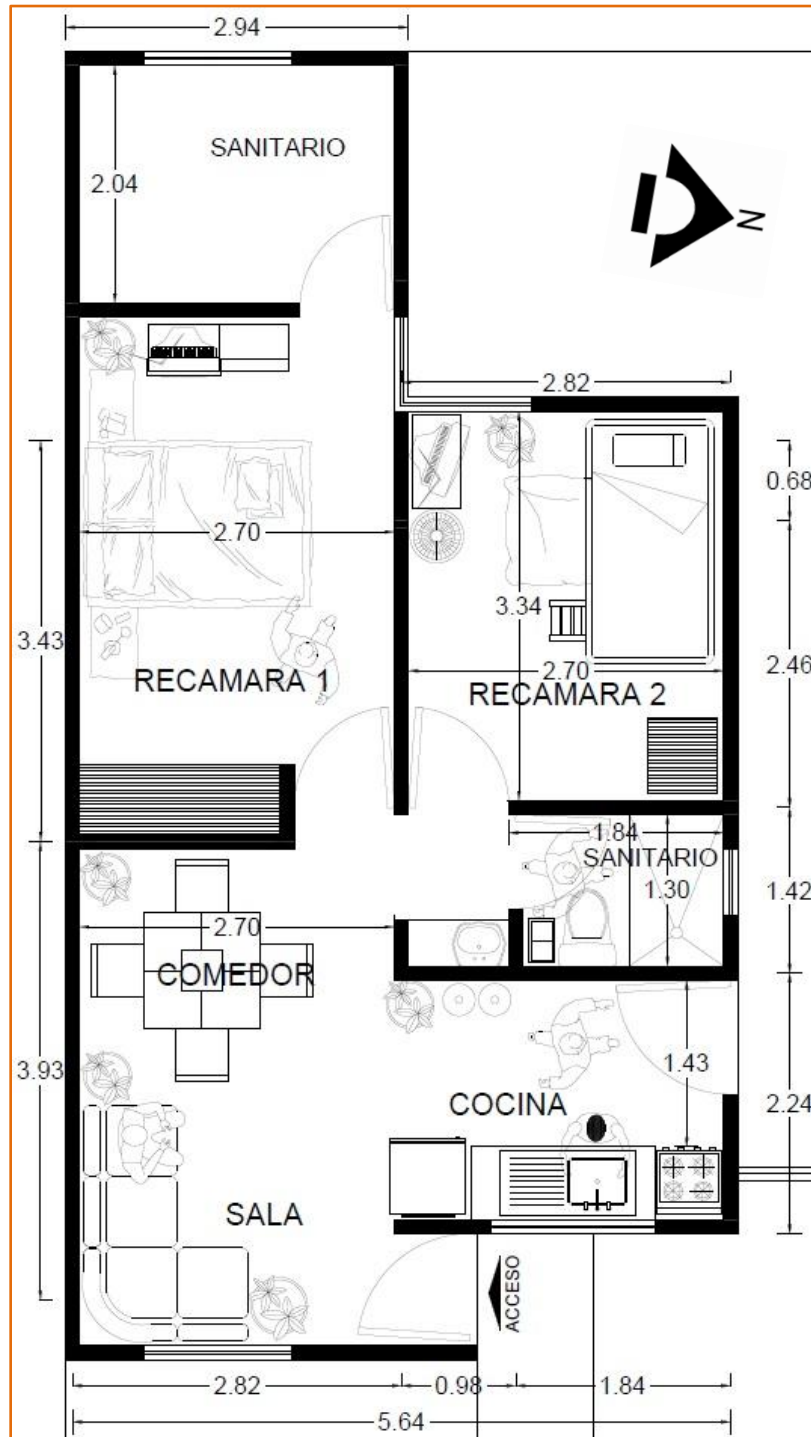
Plano de propuesta arquitectónica para caso de estudio 2.
